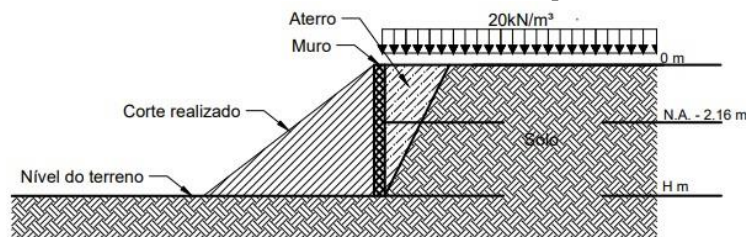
Perfil natural do solo, talude e indicação do muro (sem escala)
